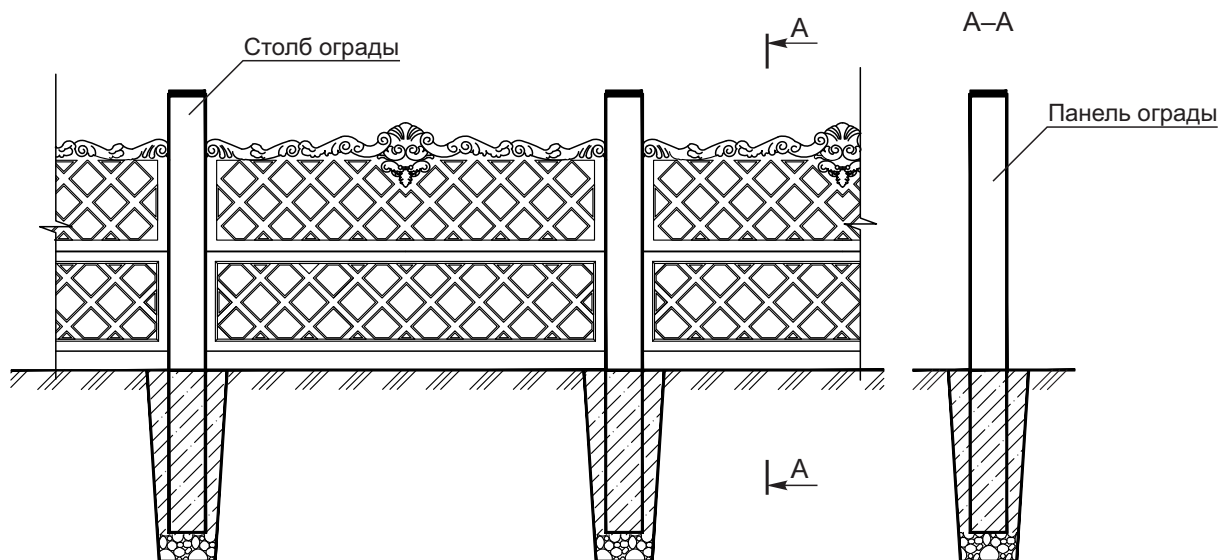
Постоянная ограда из декоративных сборных железобетонных панелей и столбов с монолитным фундаментом
